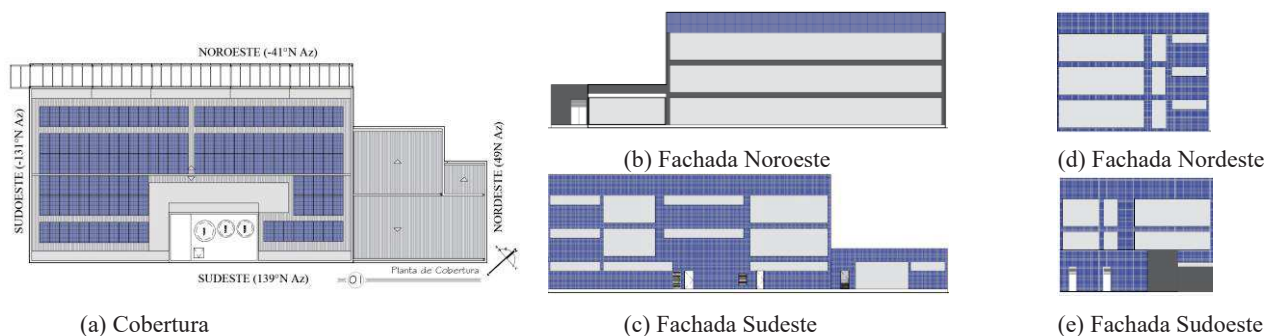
Áreas disponíveis da cobertura e fachadas para aplicação de SFV (PAF igual a 50%).
